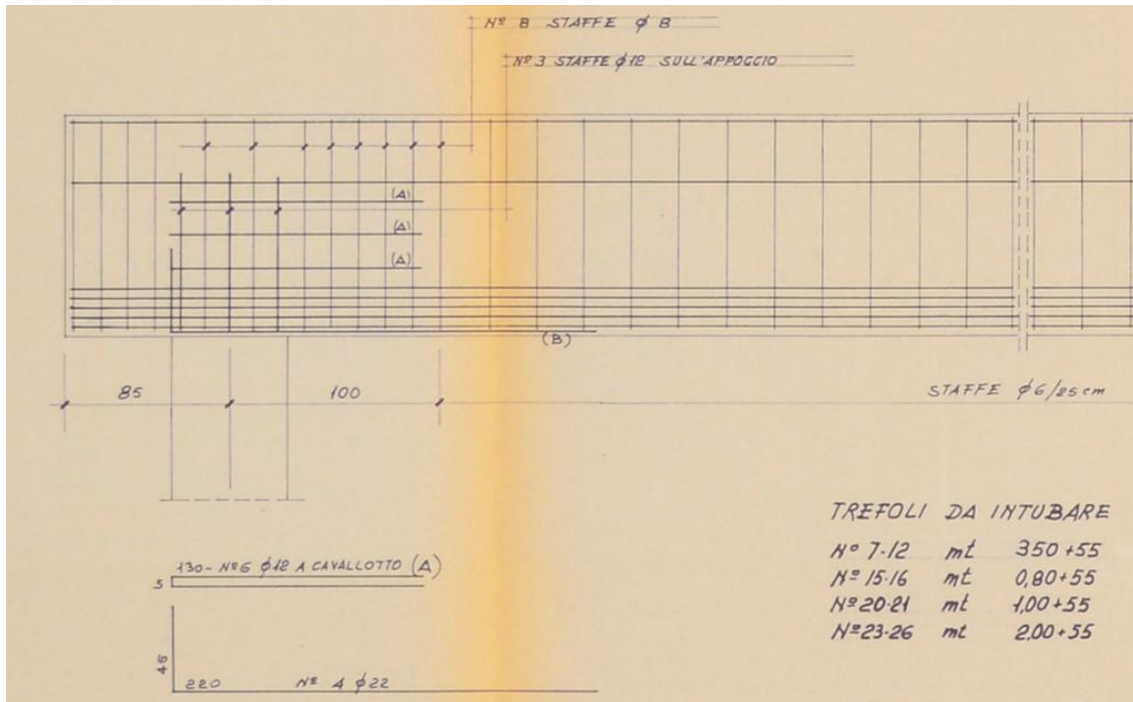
Particolare di A.1980.cap.us.T04 - Dettagli armature travi - Semi sezione longitudinale
